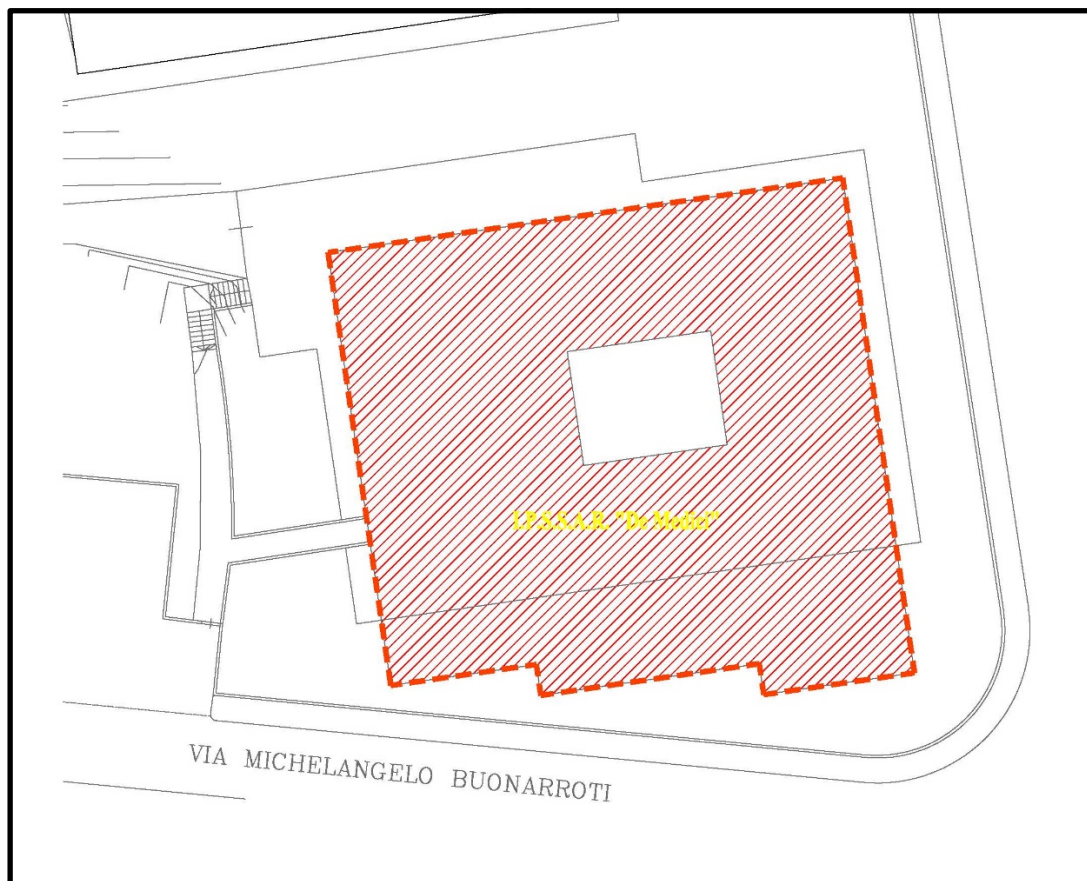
planimetria del comparto con individuazione edificio oggetto di intervento
